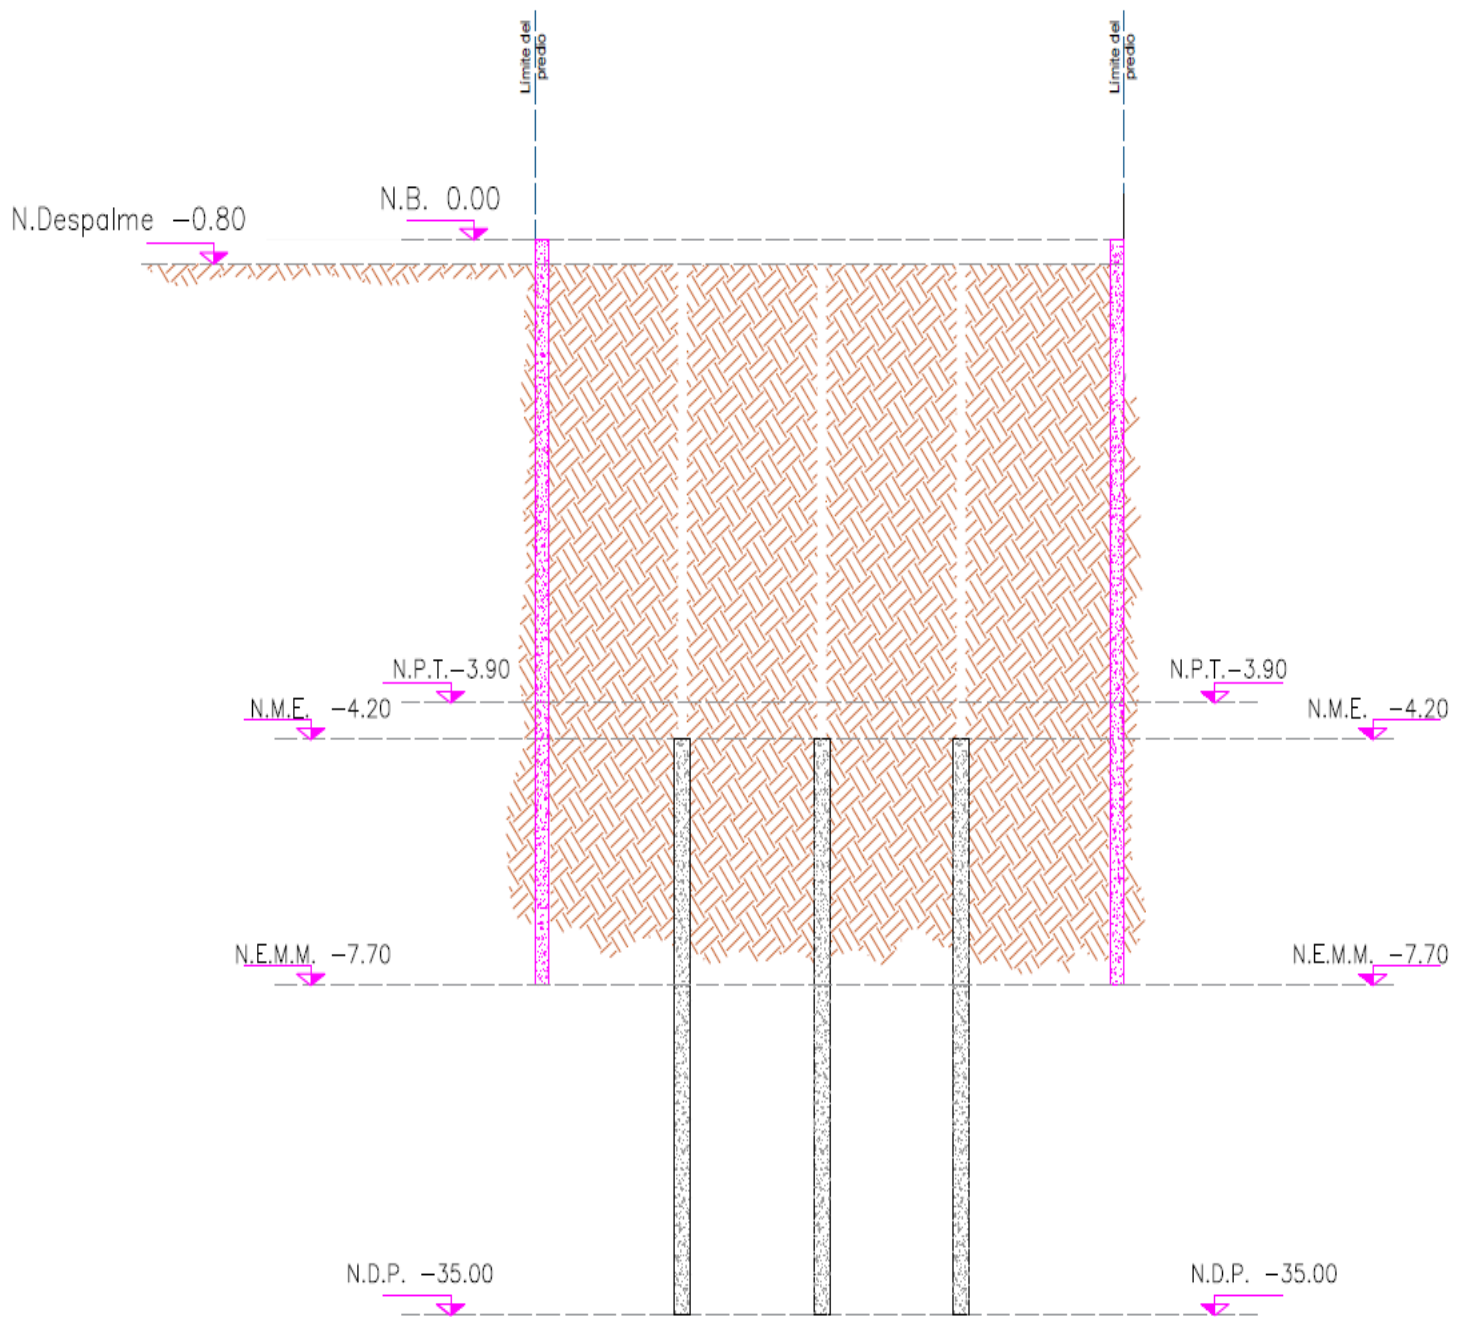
PERFORACIÓN Y COLADO DE PILAS
